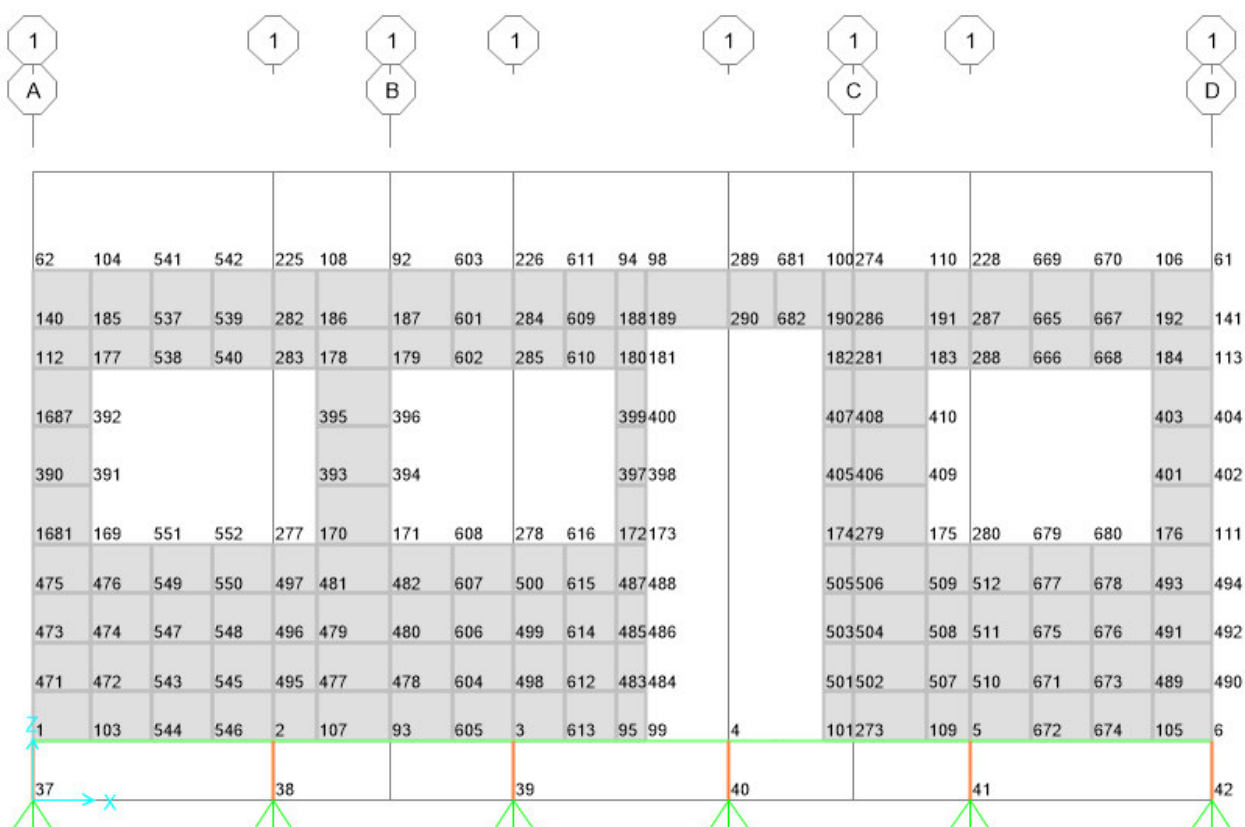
Etiquetas de Puntos - Eje 1 (Muro de Fachada): Alternativa 01
